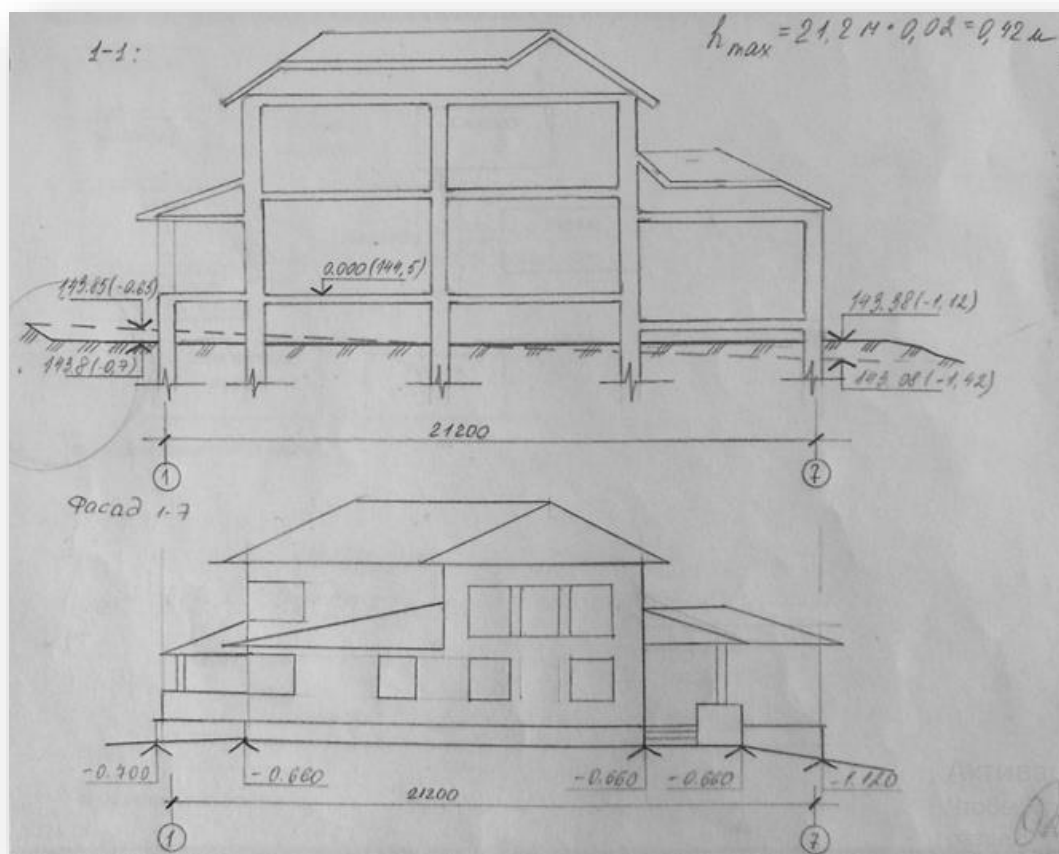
Пример разреза и фасада к схеме привязки здания к рельефу
